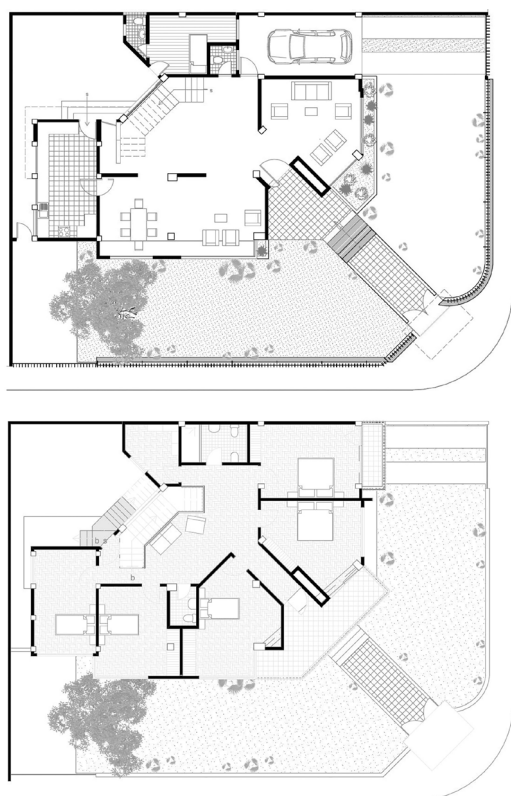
Plantas arquitectónicas casa Puertas. Dibujo:
